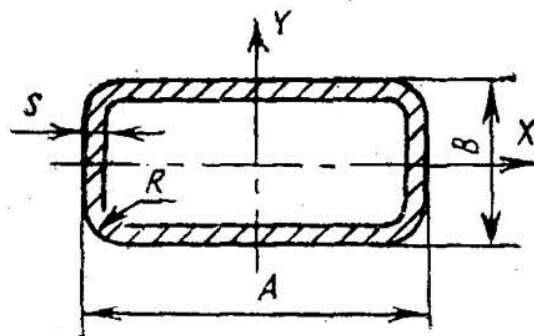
Схема сечения поперечной балки (по ГОСТ 8645-68)
